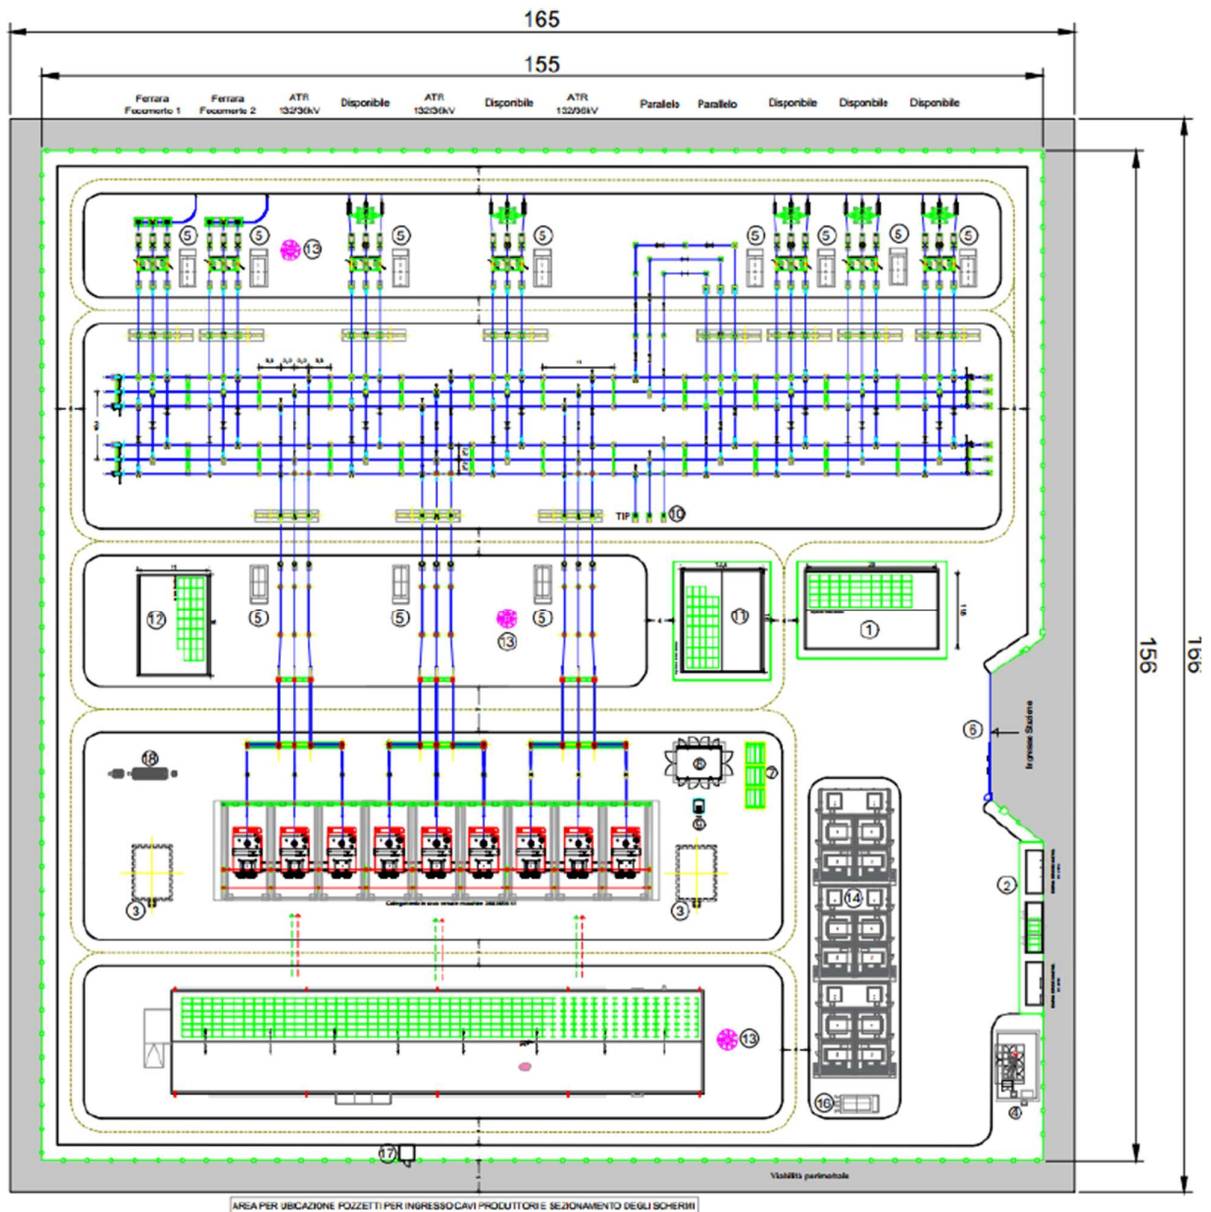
Planimetria elettromeccanica SE RTN 132/36 kV
